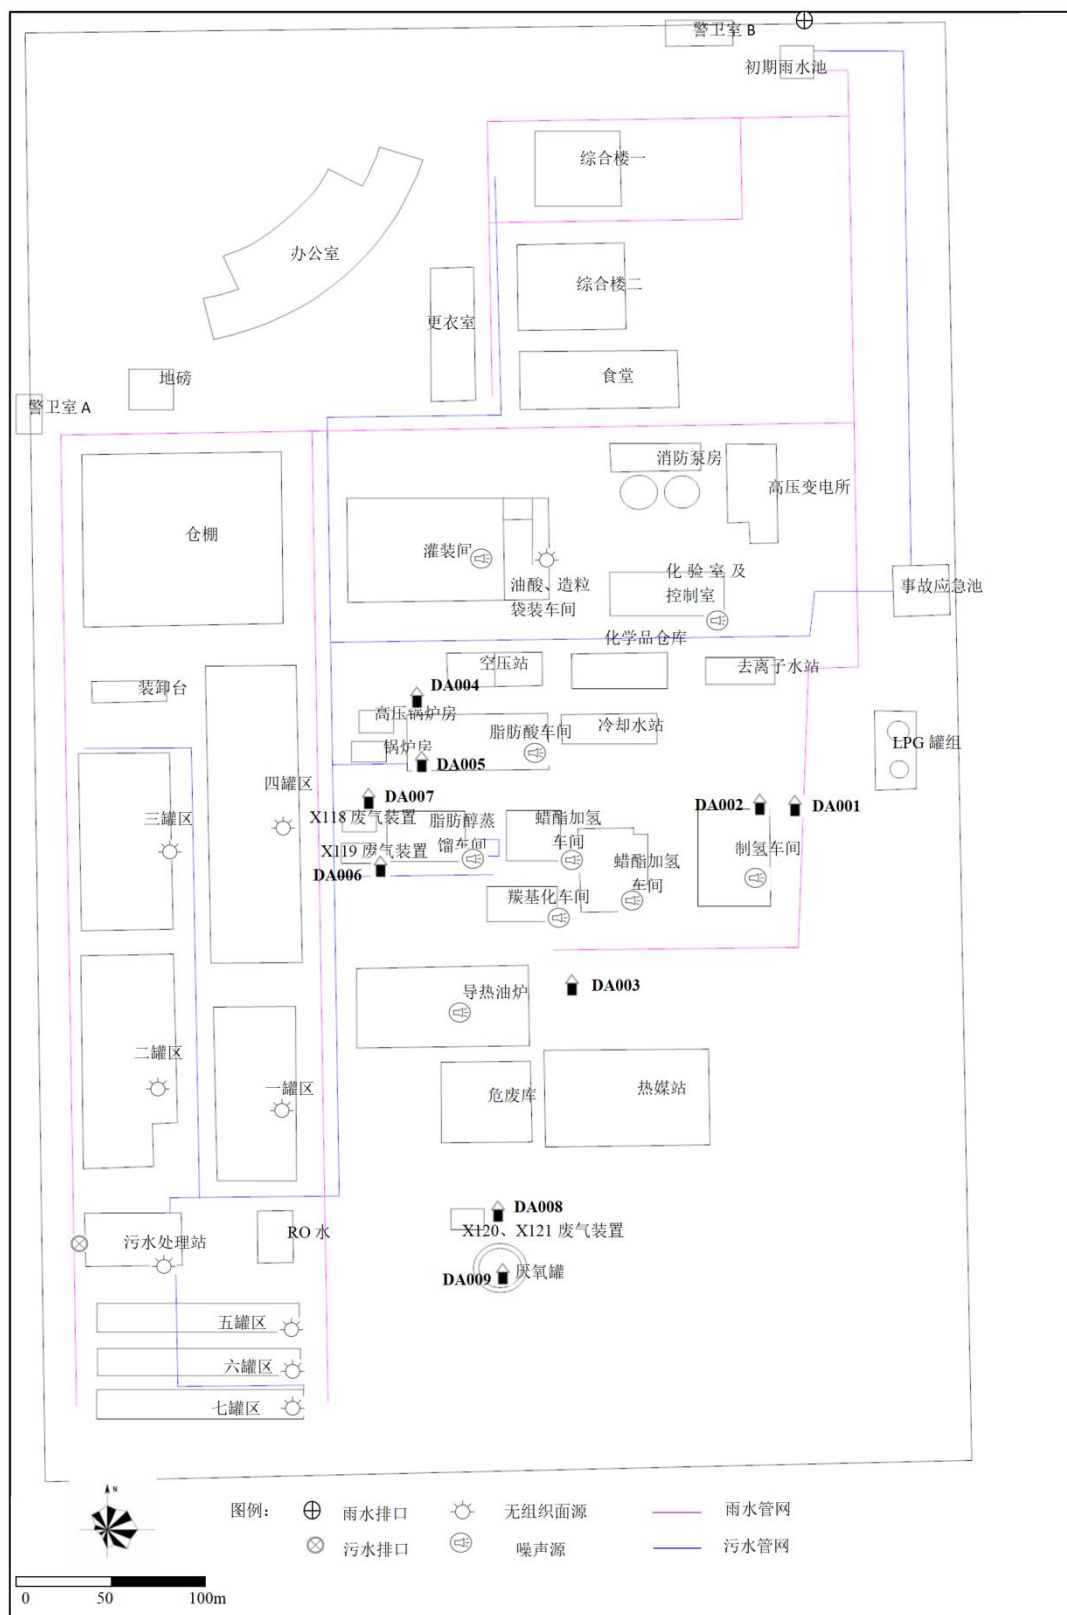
厂区平面布置对比图-环评报告中平面布置图
